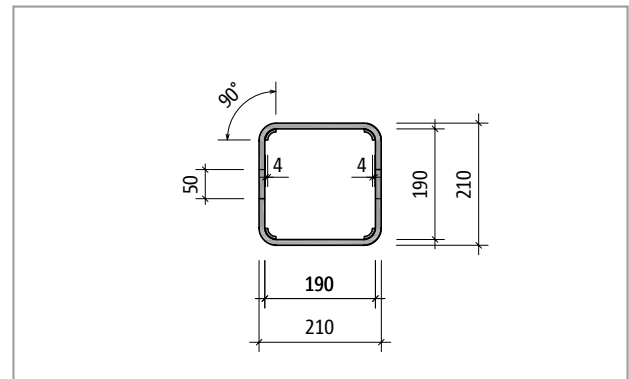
Schöck Sconnex® type P: Part T; welded stirrup and bending mould segment made of stainless steel
